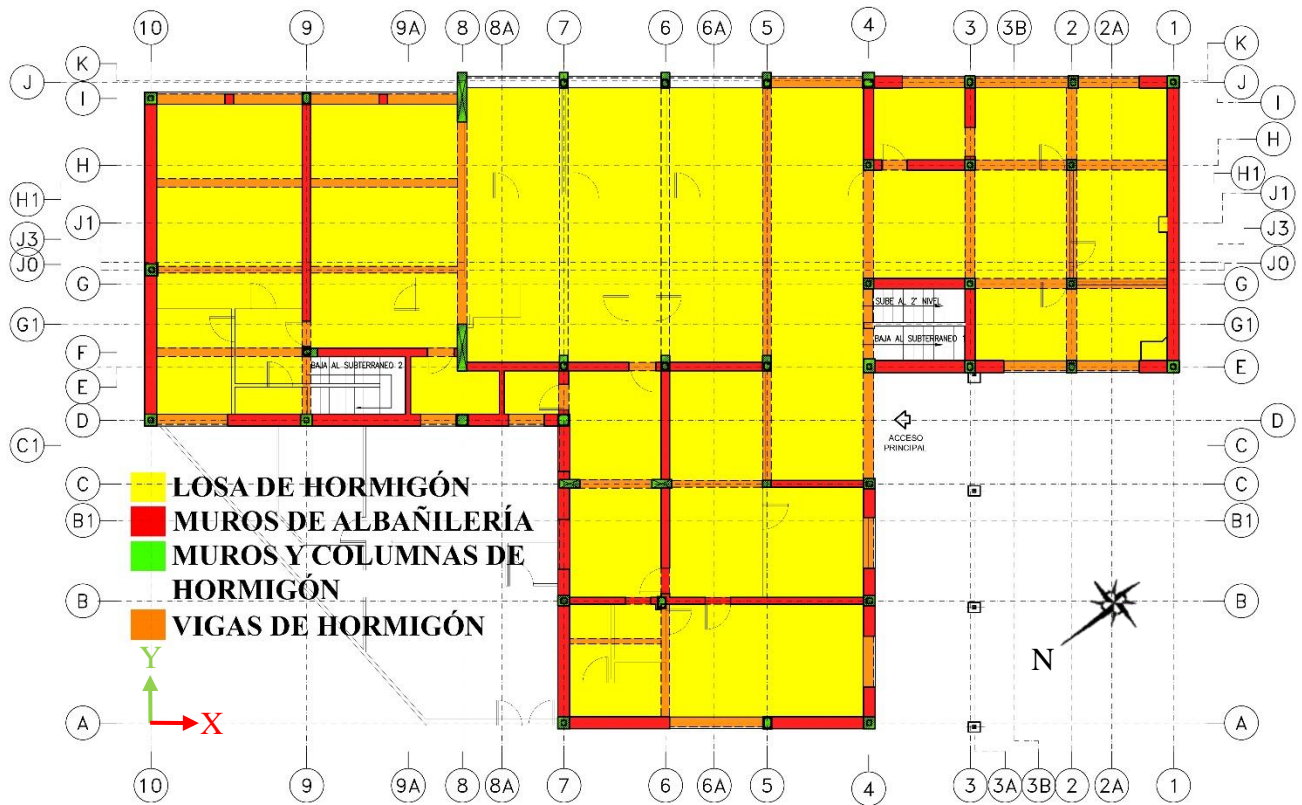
4 Planimetría, definición de elementos estructurales, primer nivel.
